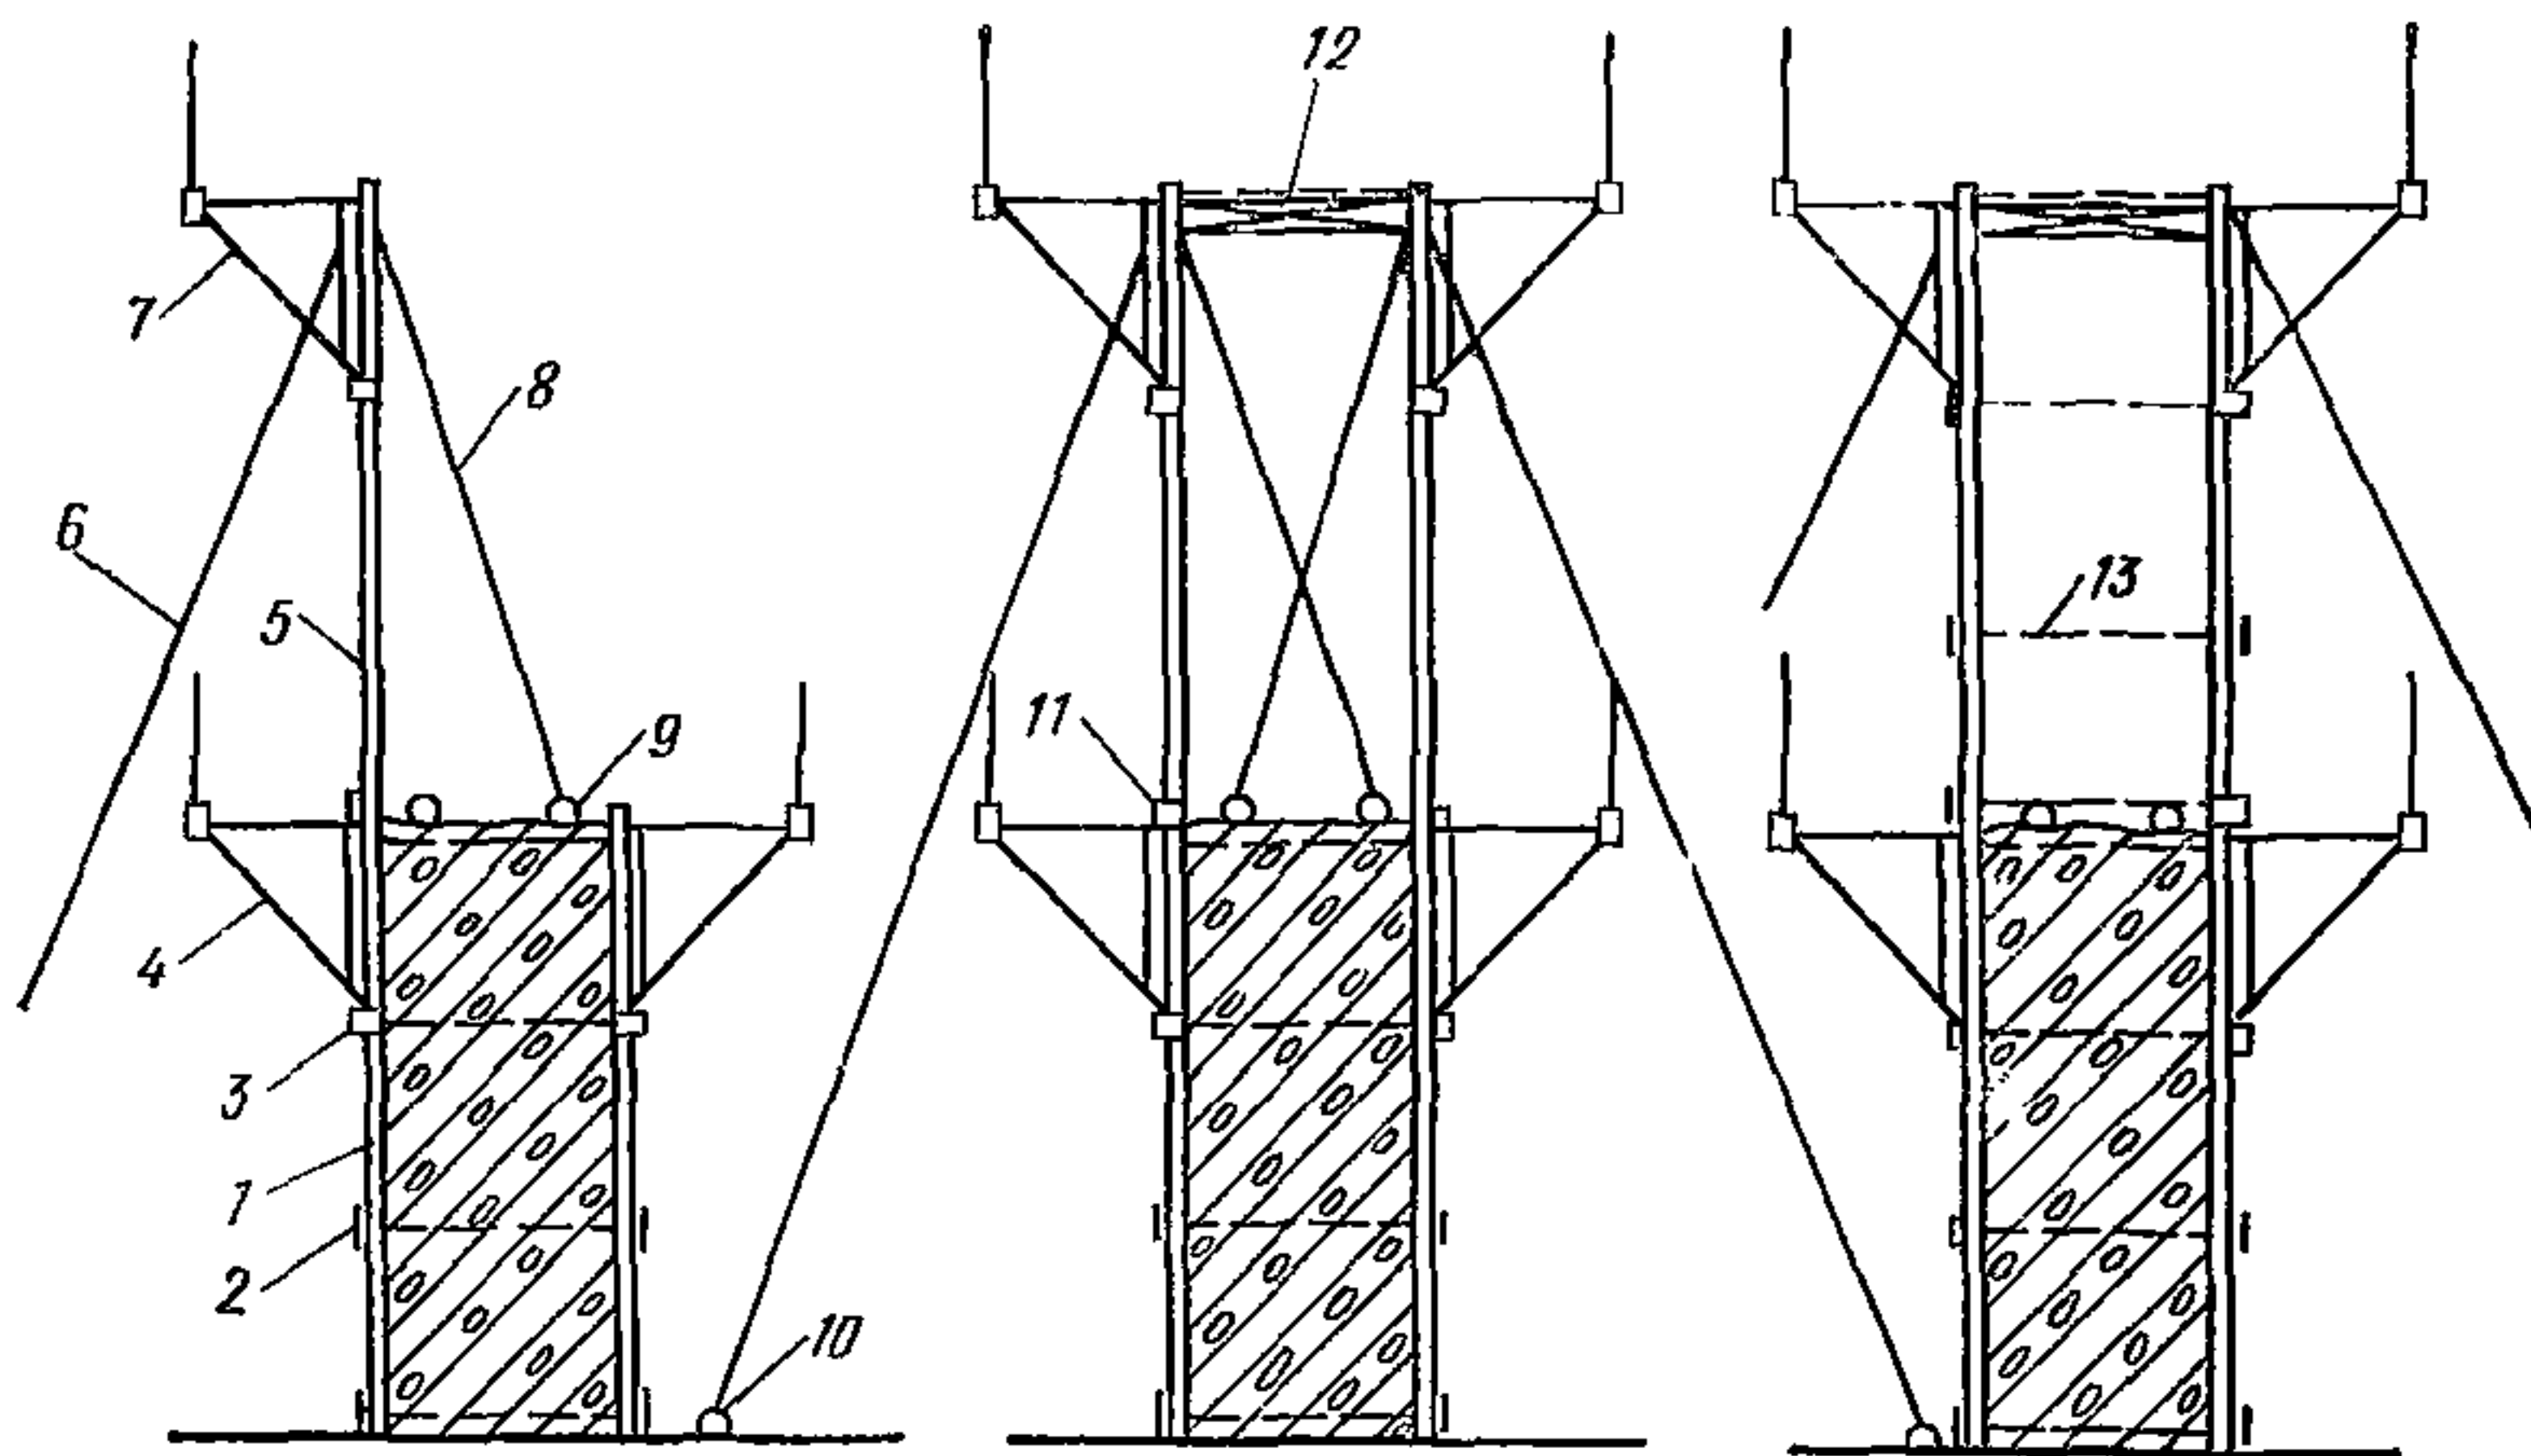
Схема установки опалубочных панелей на нижележащую опалубку
